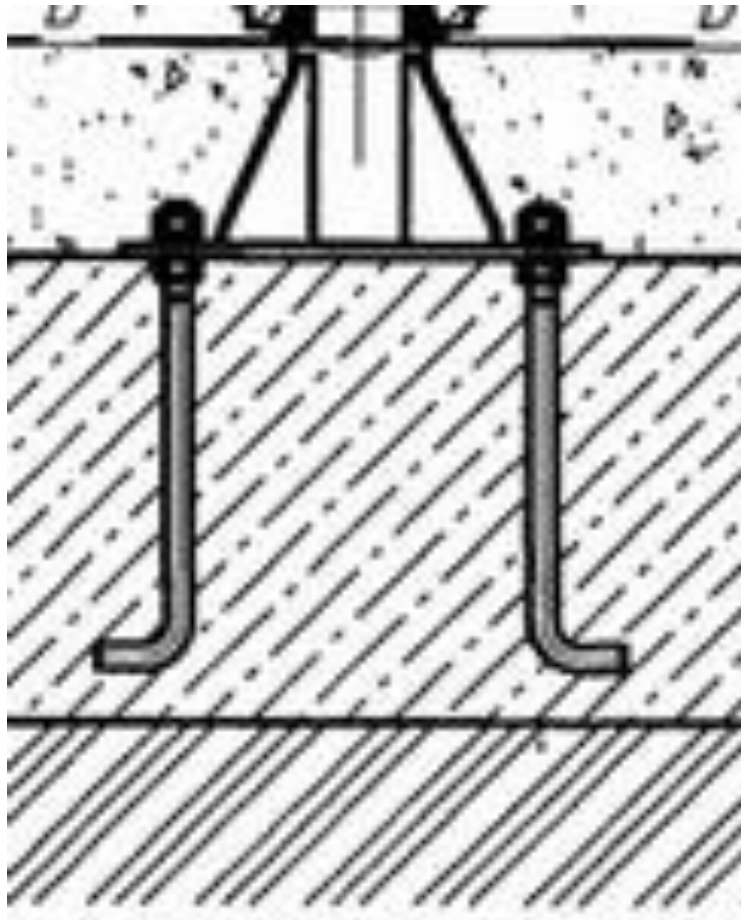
Схема чертеж крепления конструкции стержня
